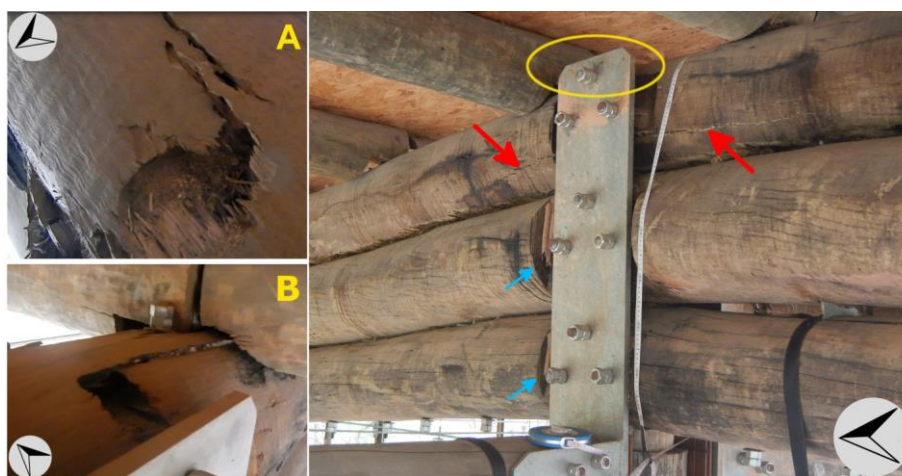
Vista lateral do Pórtico 1, na região do Pilar 3. É possível observar rachaduras longitudinais (setas vermelhas) e o recorte na peça para encaixe da placa metálica (setas azuis). As imagens A e B são destaques da superfície acima do poste superior, indicando a ruptura da peça.
